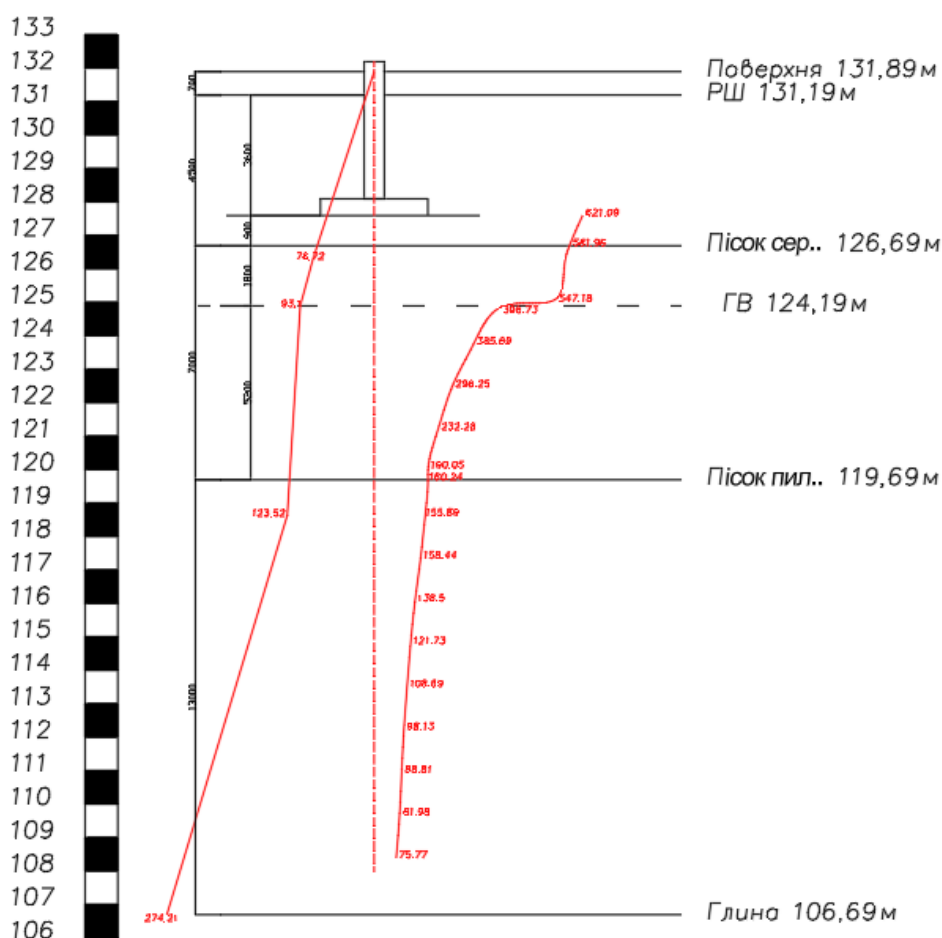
Епюра стиску ґрунтів під фундаментом
